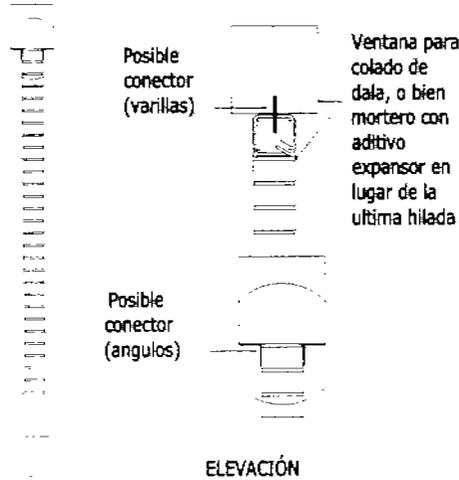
DETALLE DE MURO DIAFRAGMA
